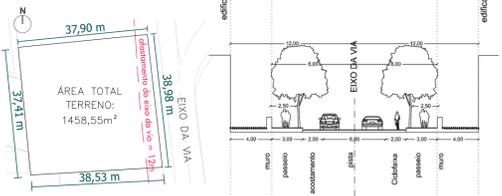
Dimensões Terreno. Fonte: Autora, 2023. Figura 07 - Perfil viário Rua São Cristóvão. Fonte: Anexo C14 Plano Diretor vigente
